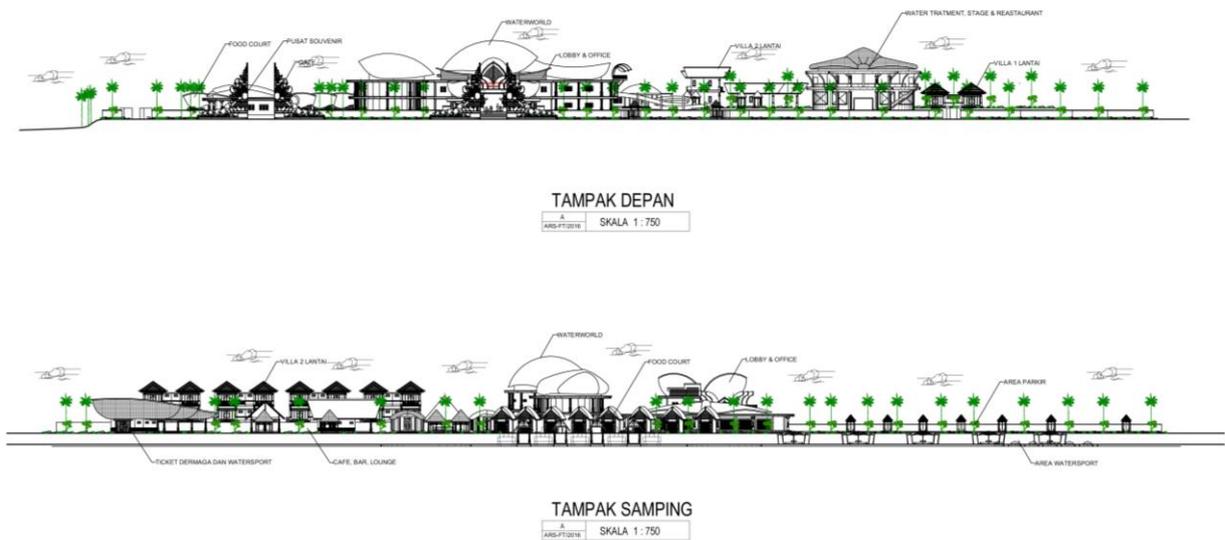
Site plan wisata air di Gunaksa, Klungkung
